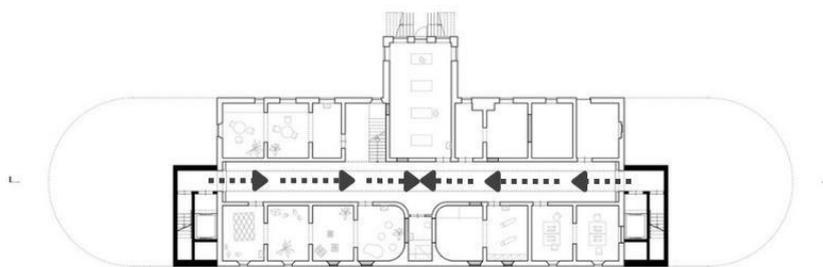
Planta 1º pavimento com fluxo do Centro de Atendimento Porcheresse
